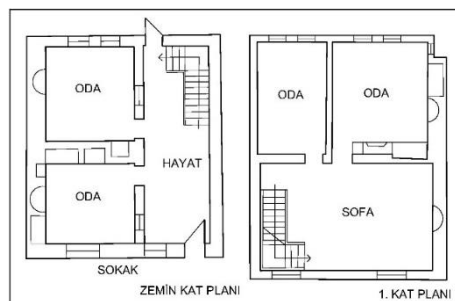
Hasan Okan Evi kat planları (Sayan, 1995 çizimlerinden güncellenmiştir) (Hasan Okan House floor plans (updated from Sayan, 1995 drawings))
